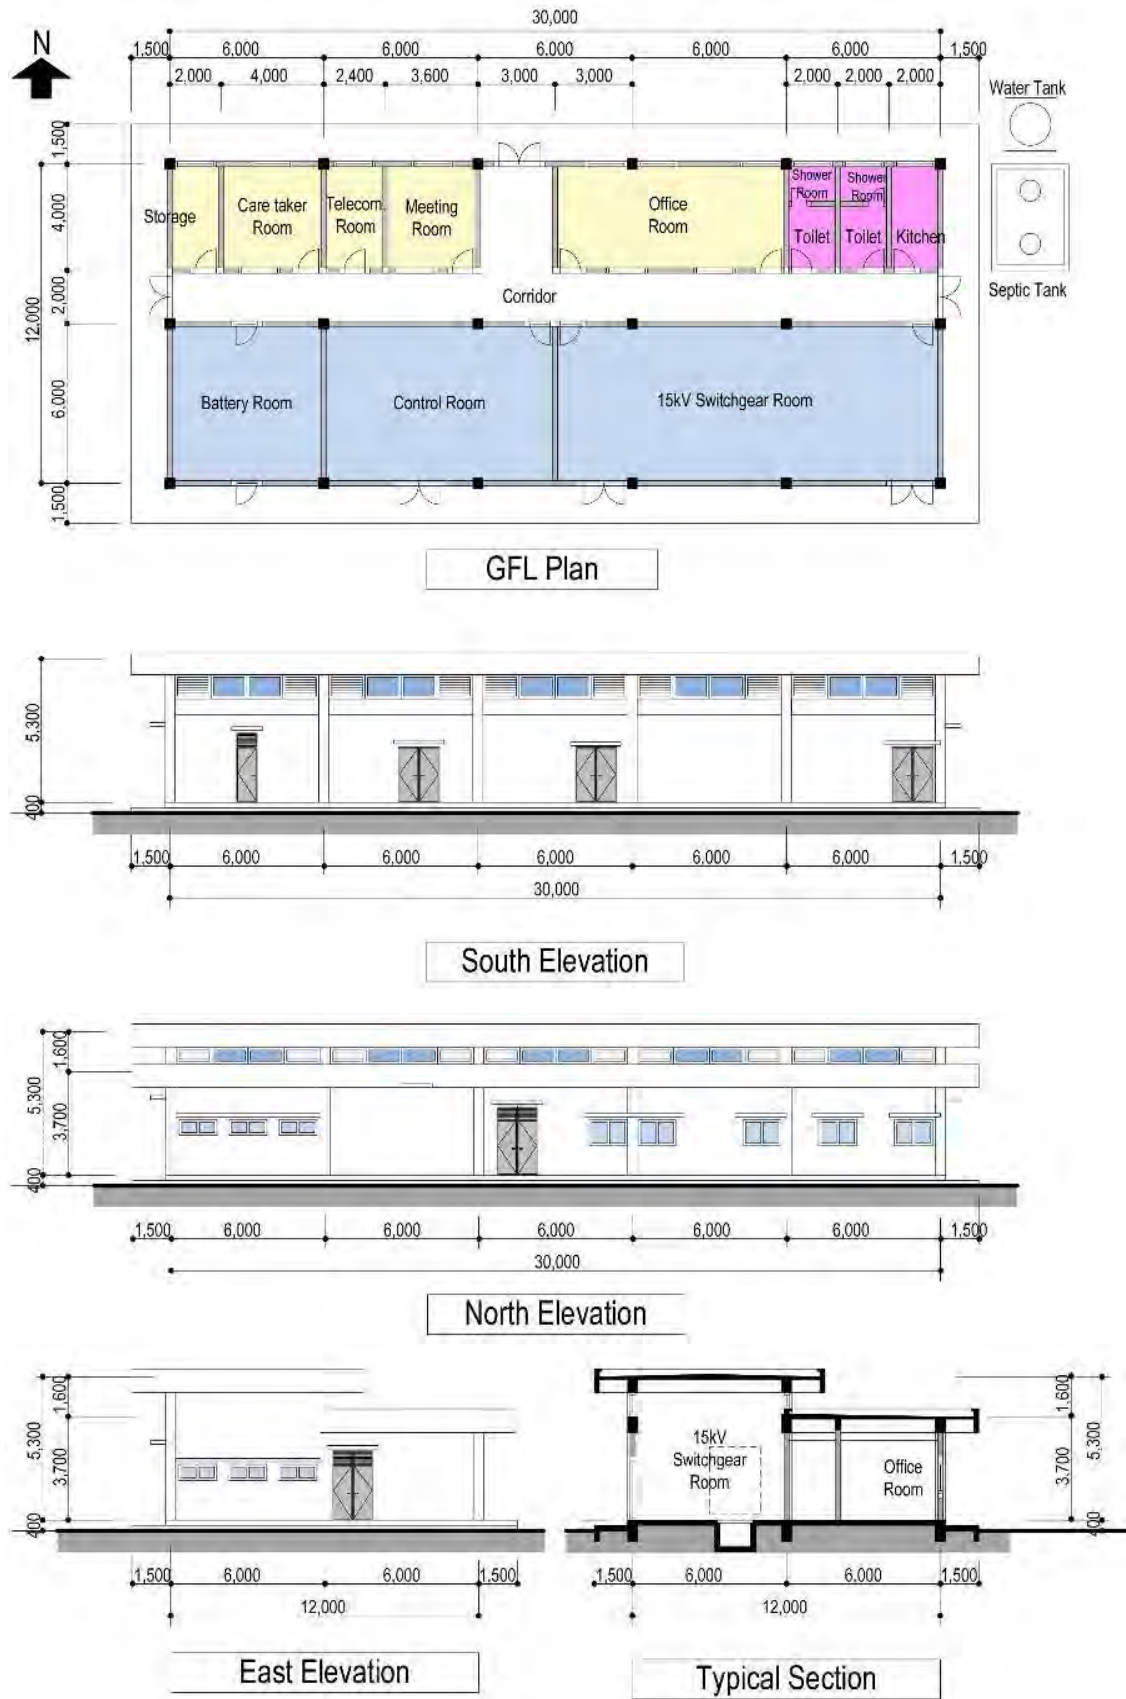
制御棟平面图·立面图·断面图
